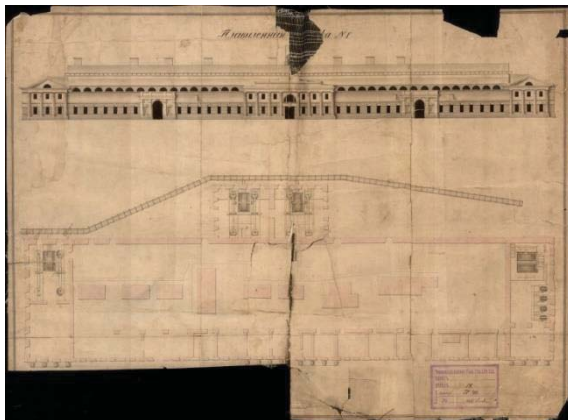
Фасад и план I-й барнаульской серебряноплавильной фабрики, XIX век
